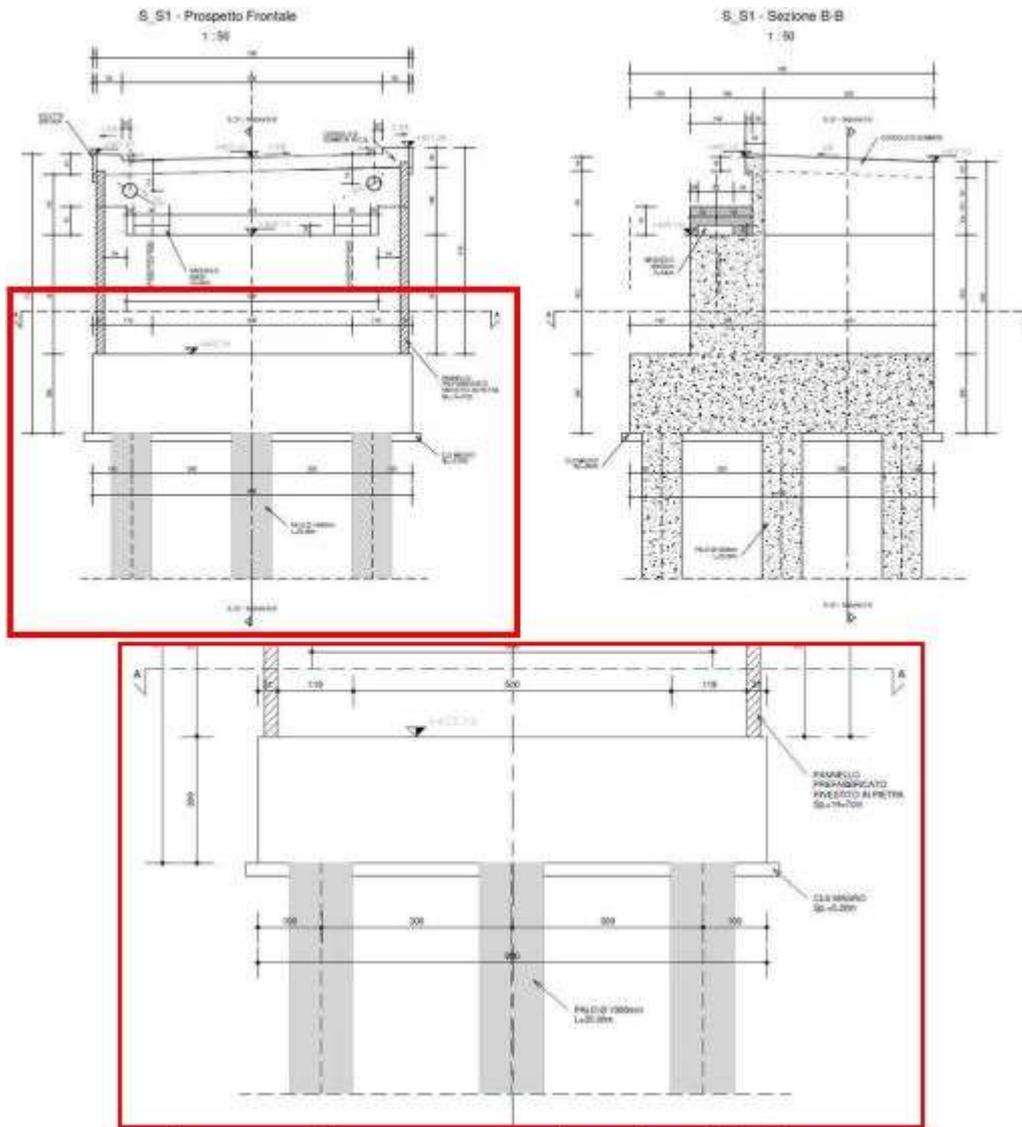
Spalla S1 - prospetto, sezione e dettaglio fondamenta
